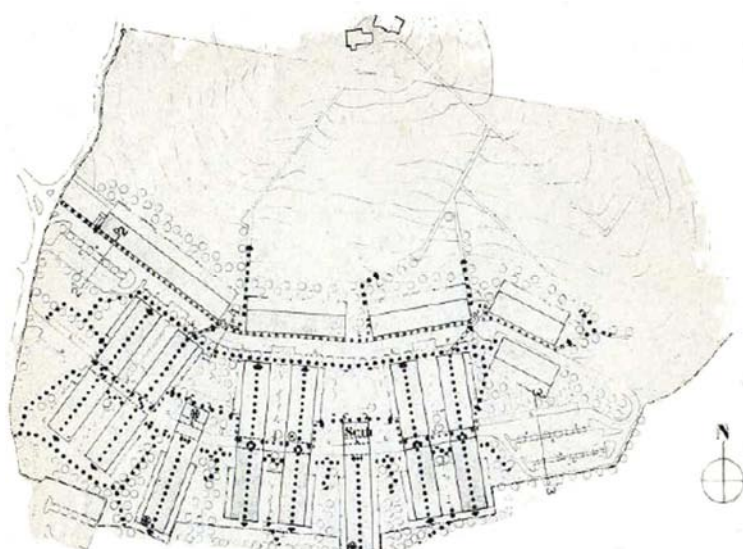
Planimetria generale di intervento disegnata dal gruppo di progettisti
